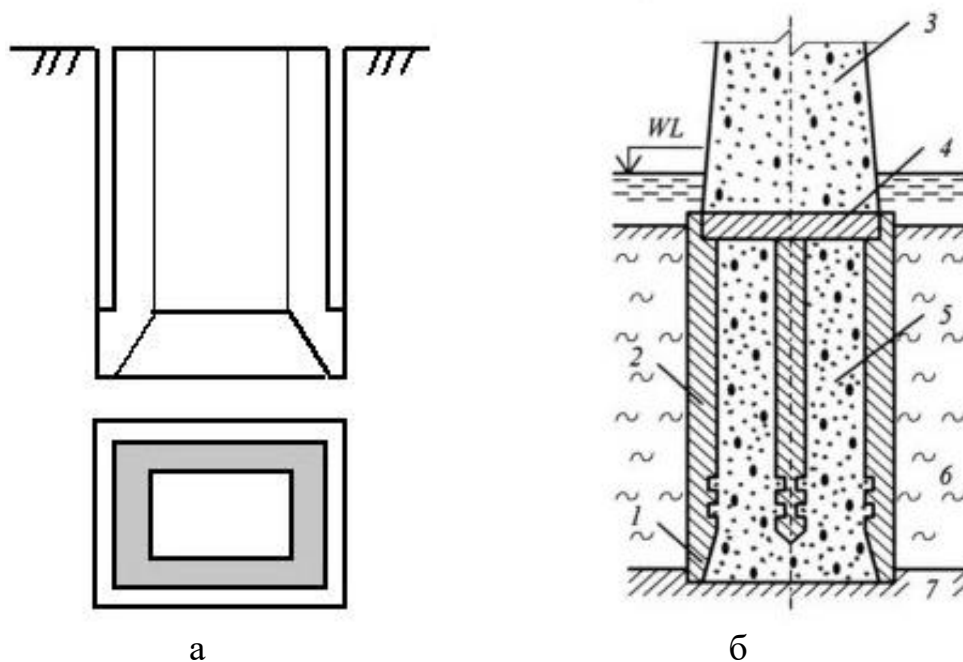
Опускний колодязь: а – схема опускного колодязя; б – фундамент у вигляді опускного колодязя; 1 – консоль; 2 – стінки колодязя; 3 – над фундаментна частина споруди; 4 – залізобетонна плита; 5 – бетон заповнення порожнини; 6 – слабкий ґрунт; 7 – міцний ґрунт
